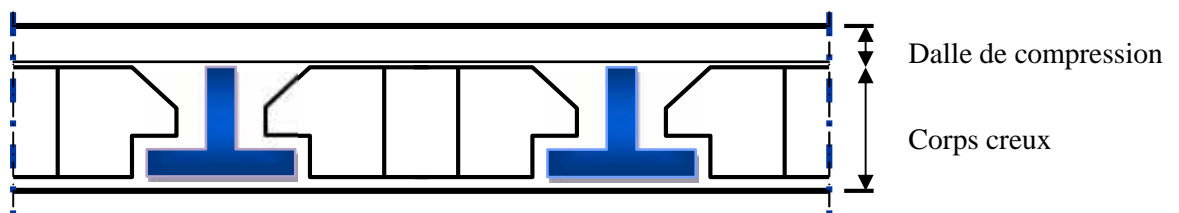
« Coupe transversale d'un plancher à corps creux »
